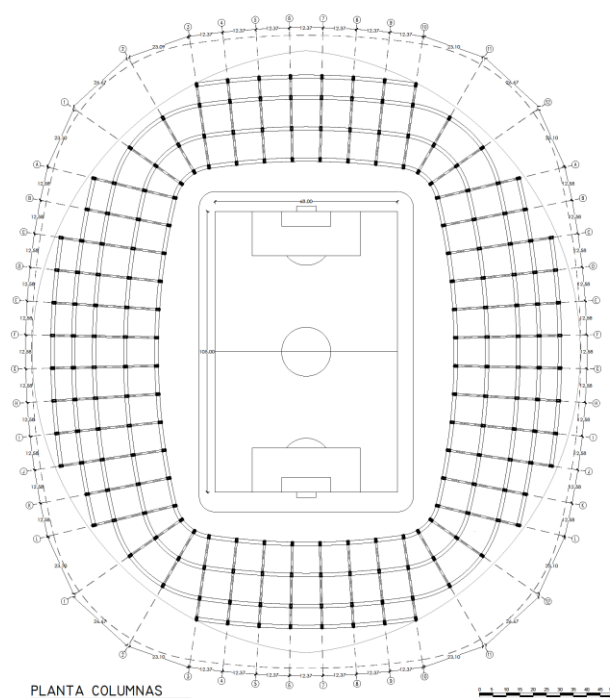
Plano de Columnas / Fuente Elaboración Propia
